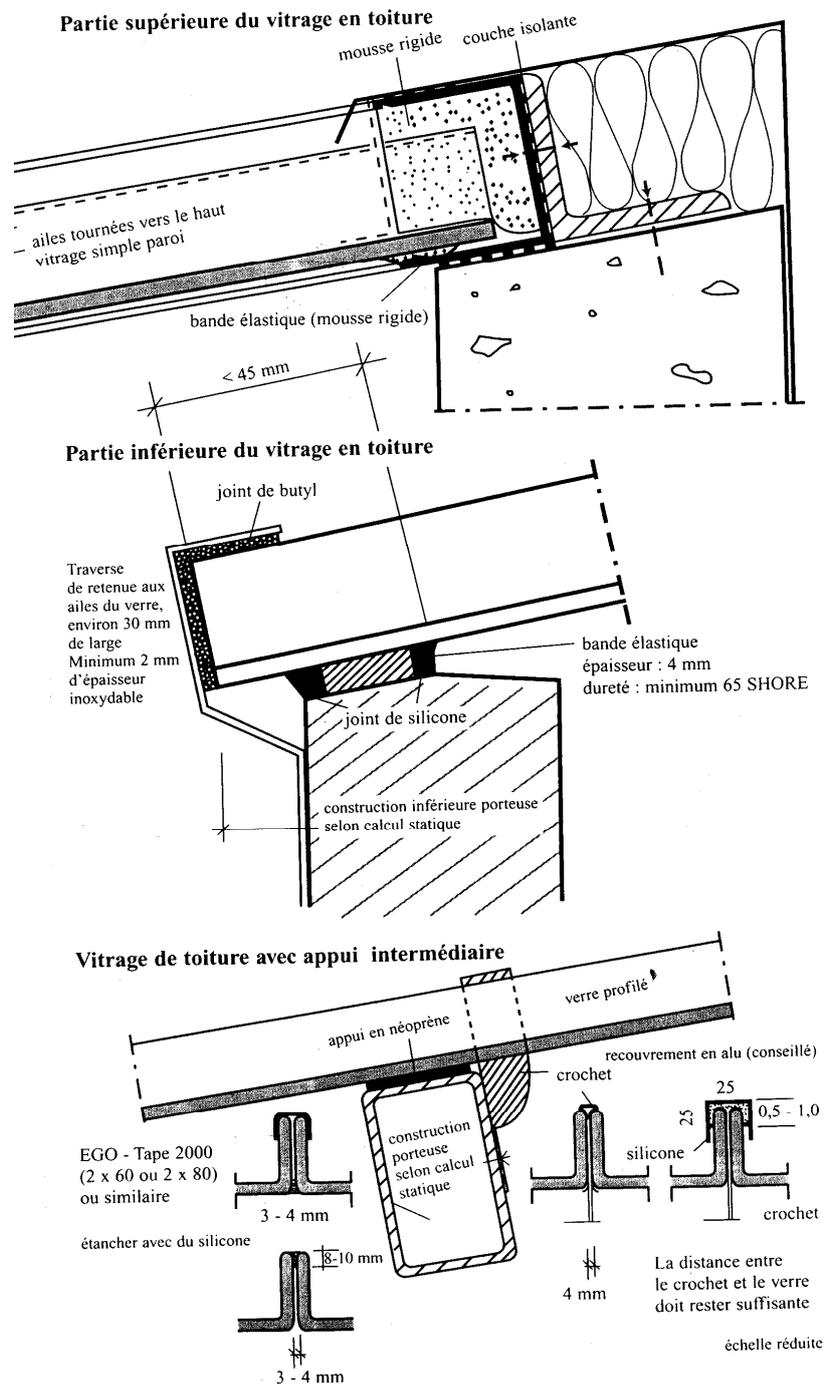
Vitrage de toiture – Pose en simple paroi – Angle d'inclinaison jusqu'à 45° par rapport à l'horizontale
